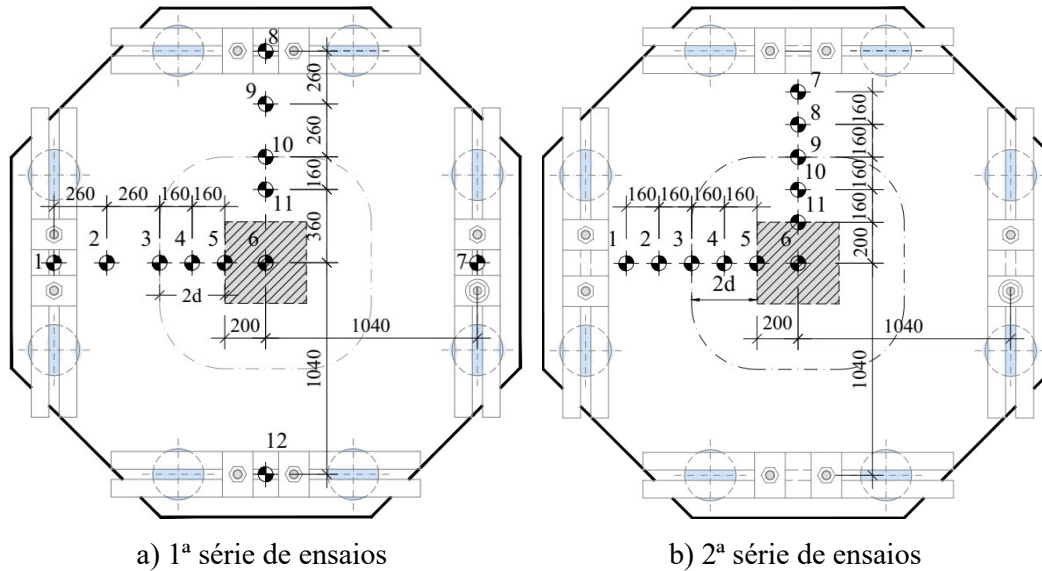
Instrumentação dos deslocamentos verticais das lajes.
